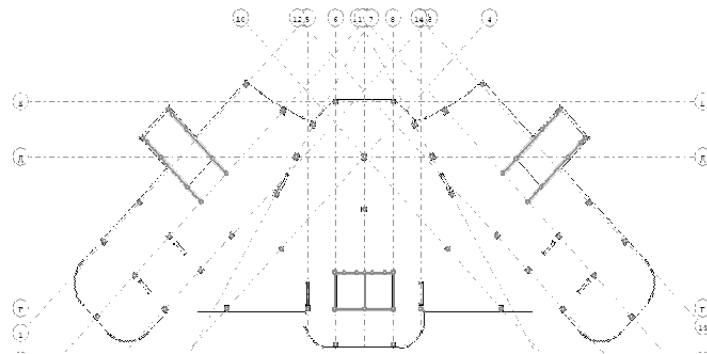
Опалубкове креслення фундаментної плити
